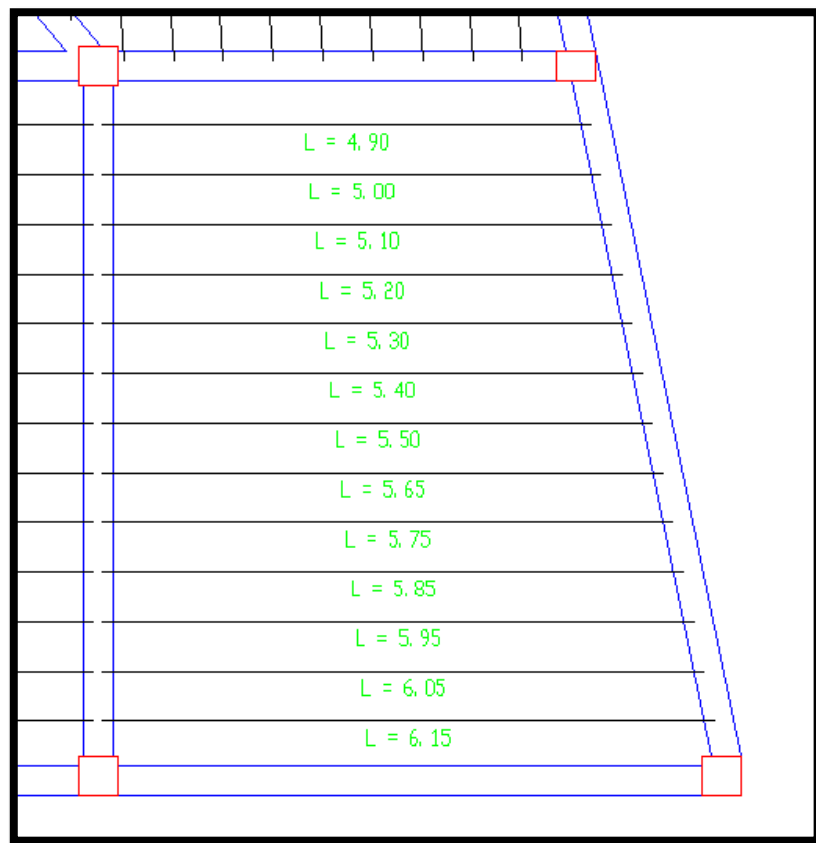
Dimensión de Viguetas de la Losa más Crítica de la Edificación
